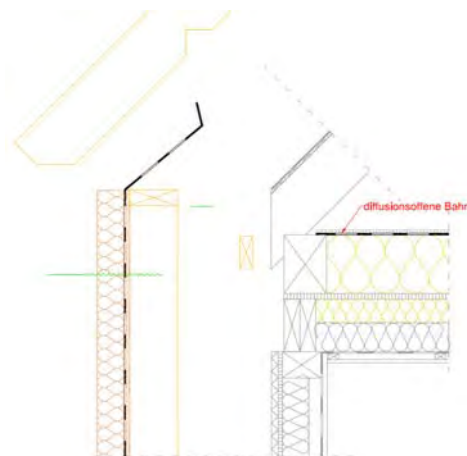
Montagedetail Traufe mit nicht ausgebautem DG
